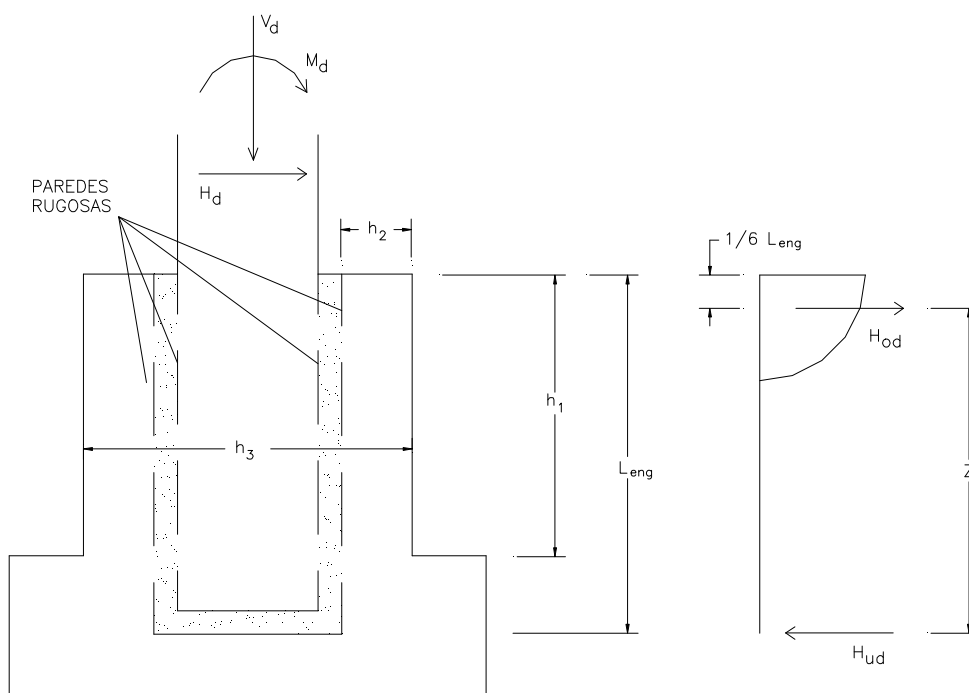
Distribuição de Tensões na Ligação Fundação-Pilar para Parede Rugosa Segundo LEONHARDT & MONNIG (1978)
